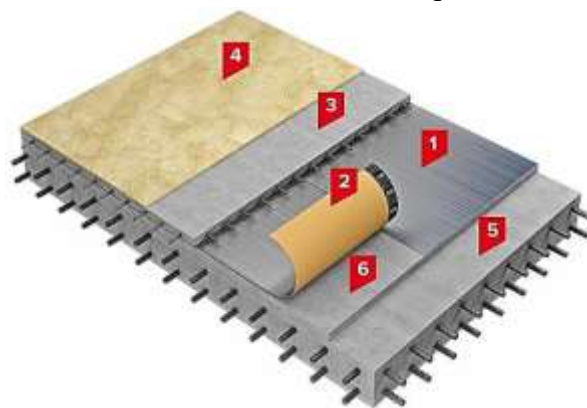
Конструктивне рішення цокольного перекриття над експлуатованим підвалом: 1 – рулонний підкладковий звукоізоляційний матеріал; 2 – стрічка-герметик самоклеюча; 3 – армована цементно-піщана стяжка (не менше 40 мм); 4 – фінішне покриття підлоги; 5 – залізобетонна плита перекриття; 6 – вирівнювальна стяжка
